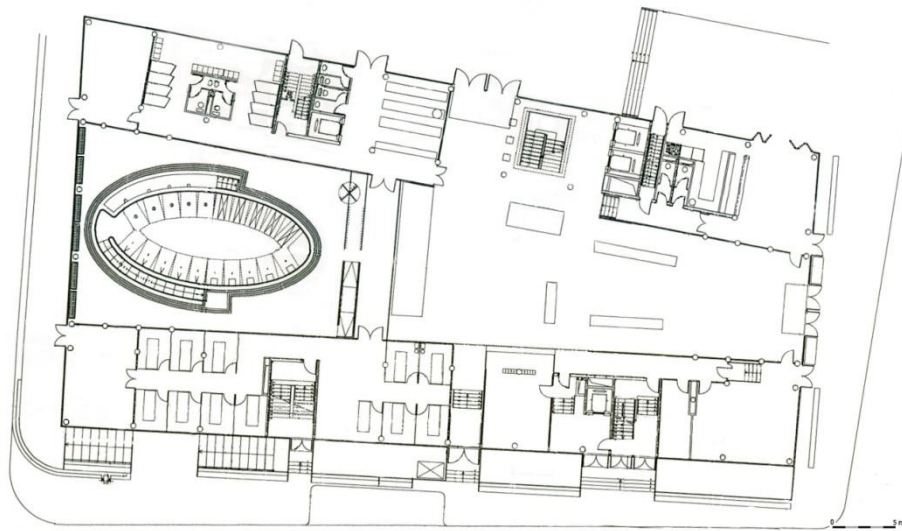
Planta do piso térreo do Hotel «Les Thermes» (1990).
